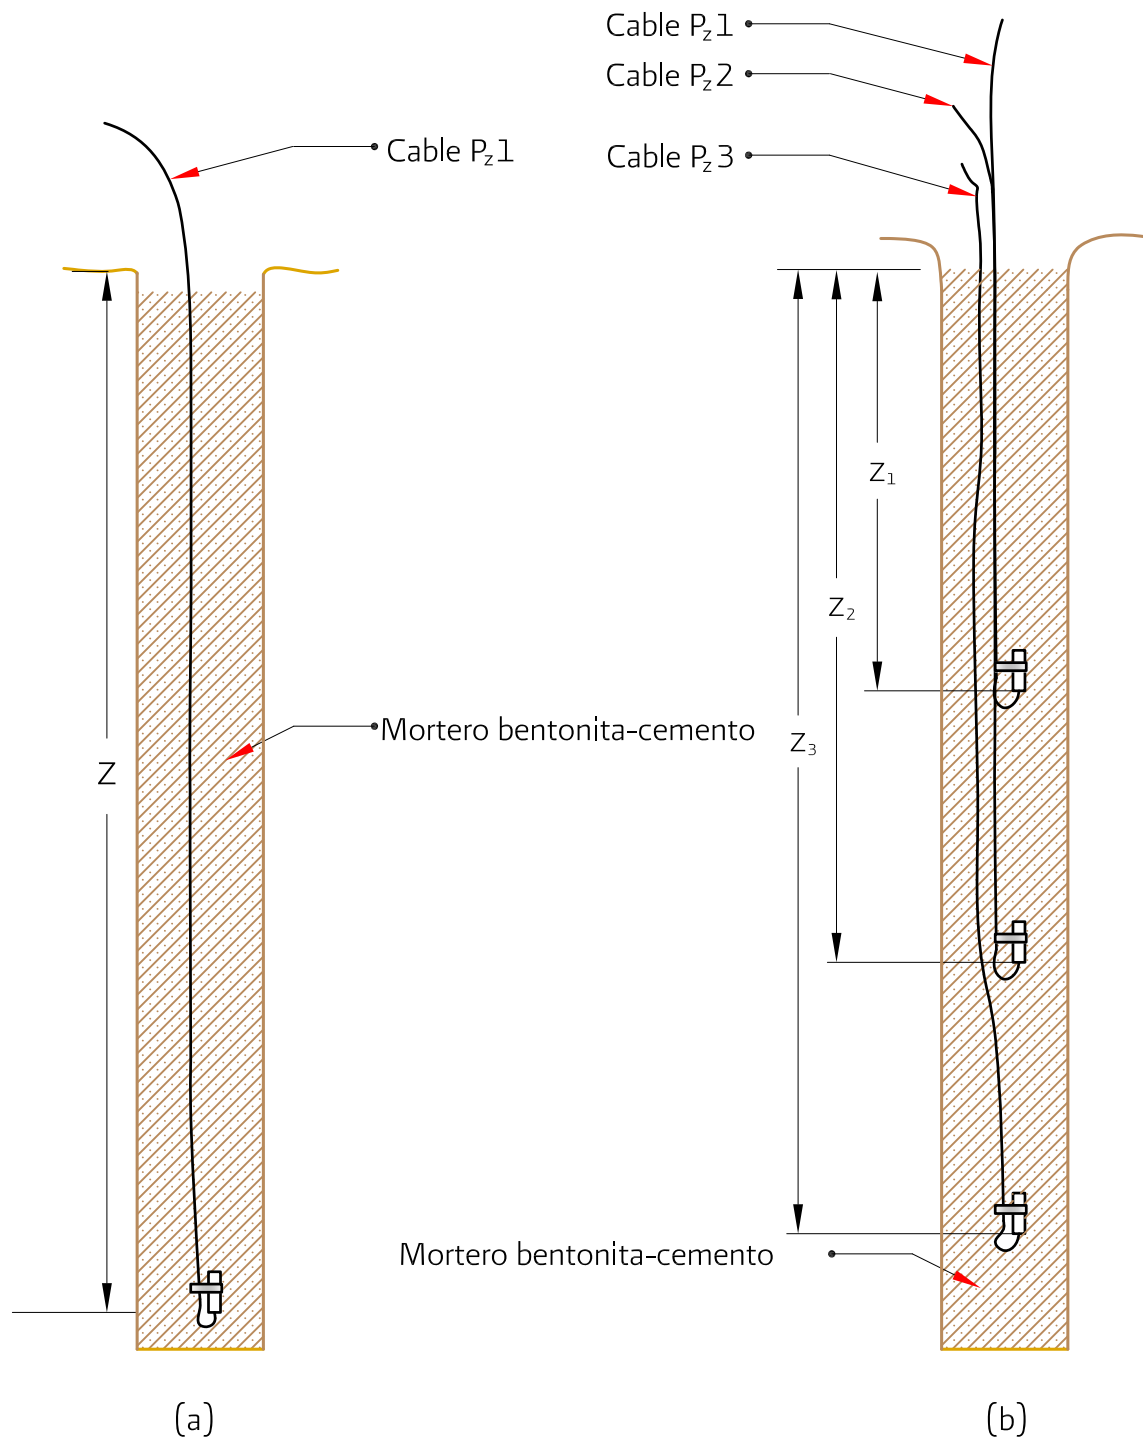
Piezómetro de cuerda vibrante instalado en un barreno sellado con mortero cemento-bentonita:
